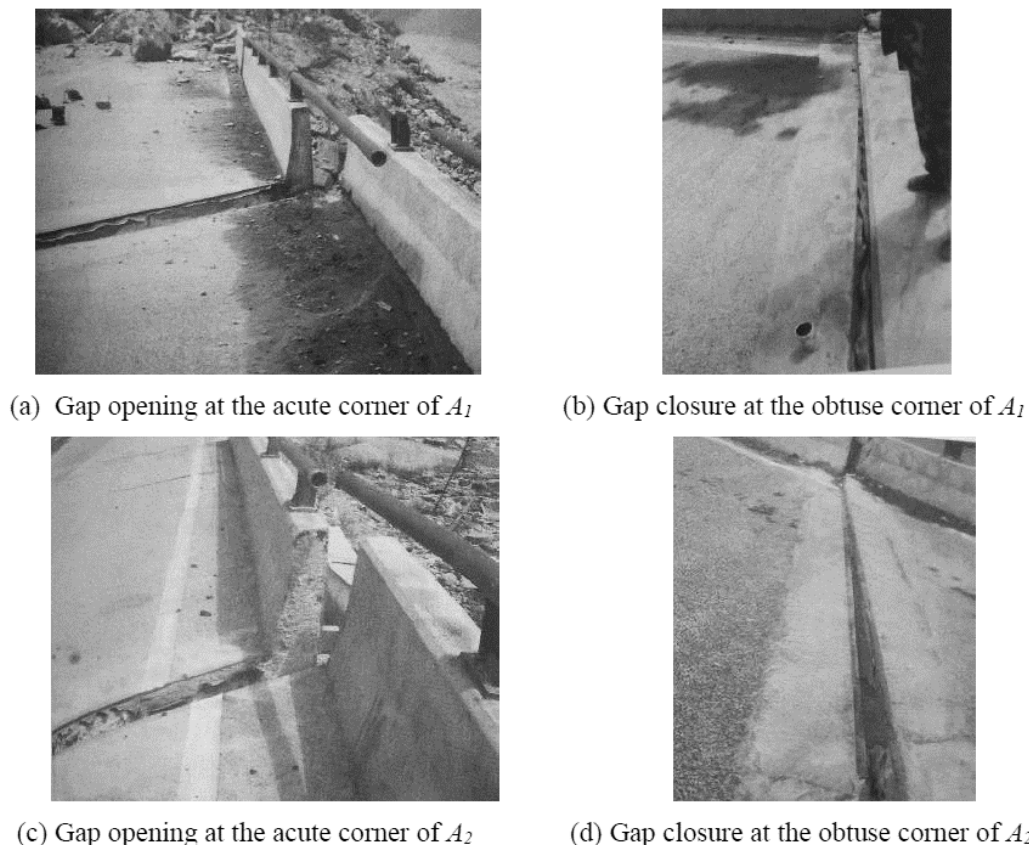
Juntas de Expansión del Puente Louquanwan en la Zona de los Estribos A_1 y A_2 , tras Terremoto de Wenchuan (2008). Fuente: [14].
